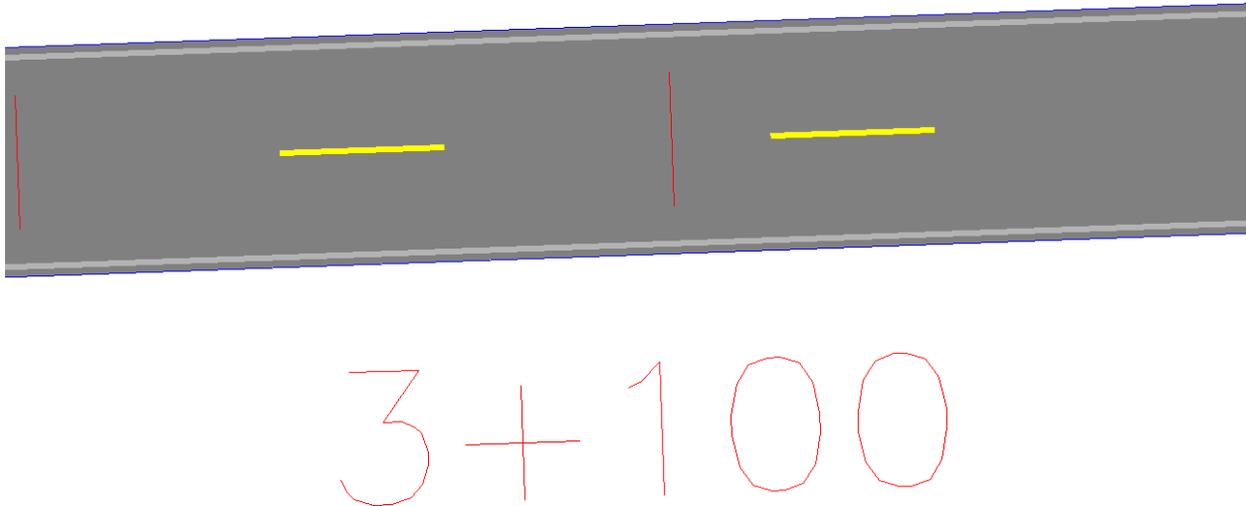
Vista en planta detalle marca M-1.5 y M-3.1.
